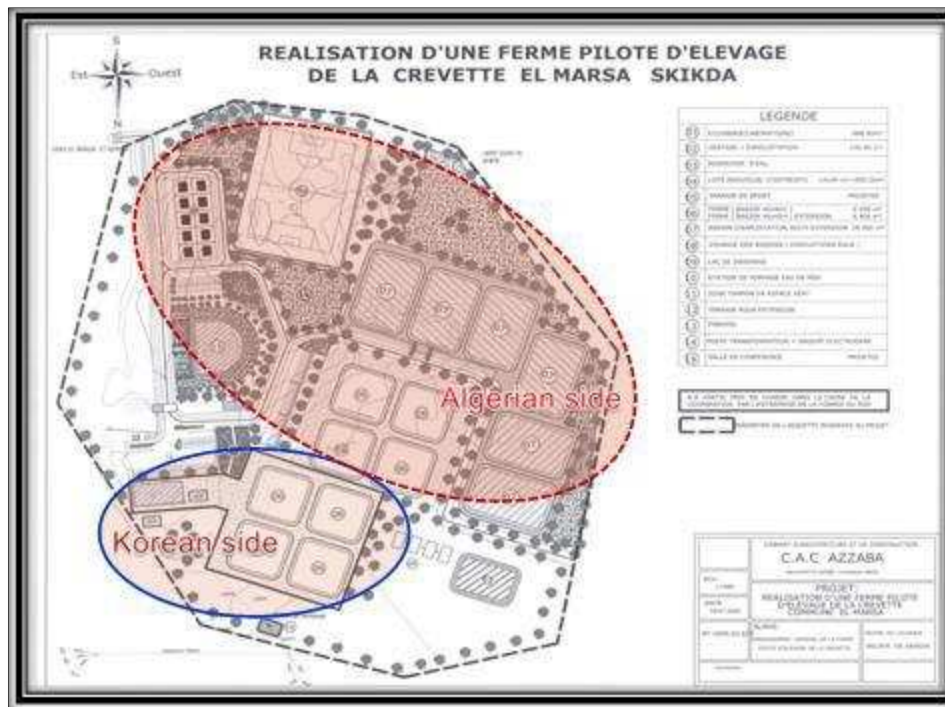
Plan de masse de la ferme pilote de crevetticulture La Marsa (document de la ferme)
